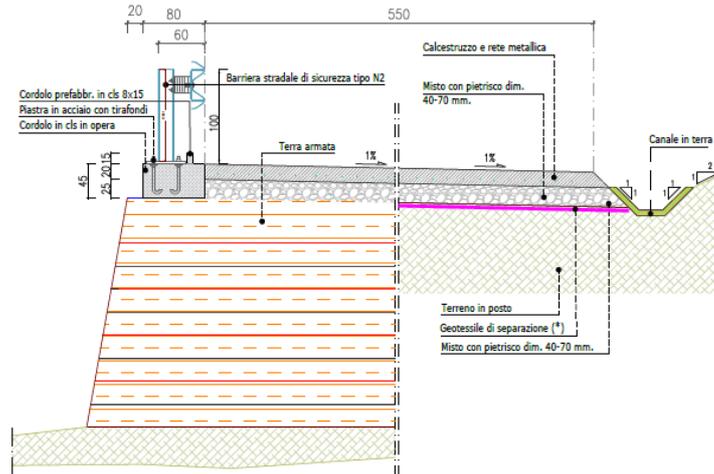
Sezione stradale su terra armata con elementi di ritenuta
